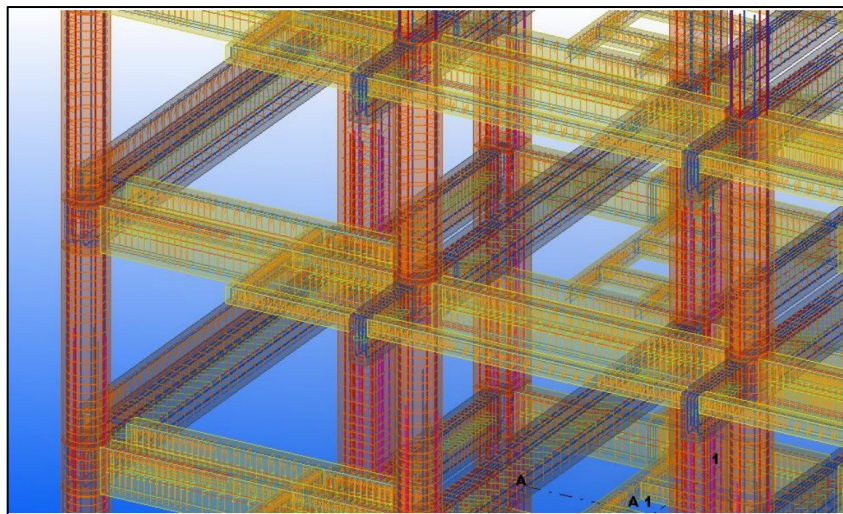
Detallamiento de acero de refuerzo en el software Tekla Structures. Fuente: Valle (2015)
